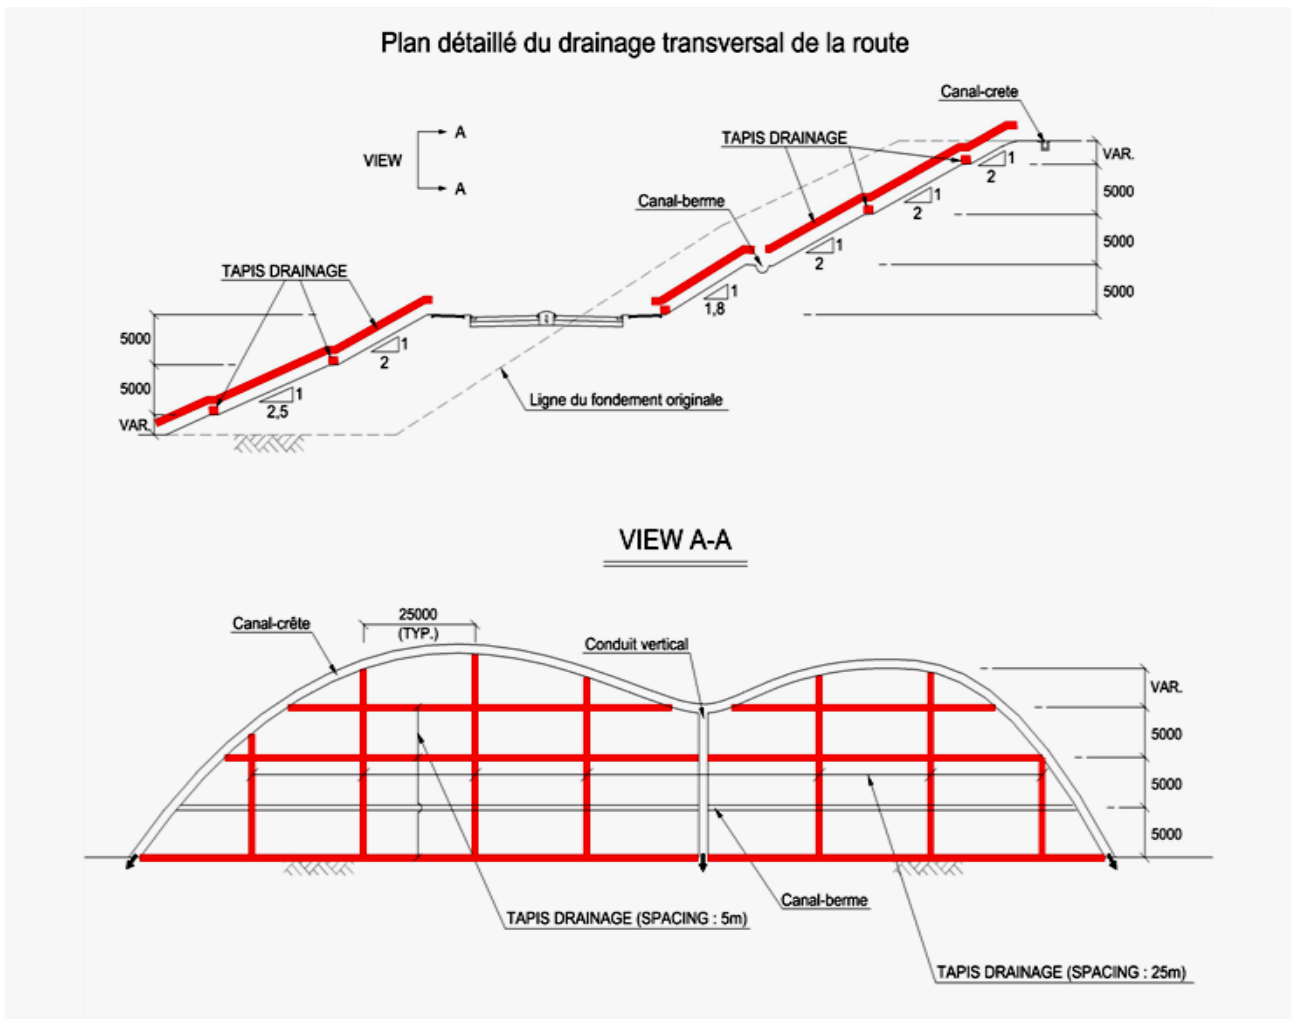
Plan détaillé du drainage de l'inclinaison
